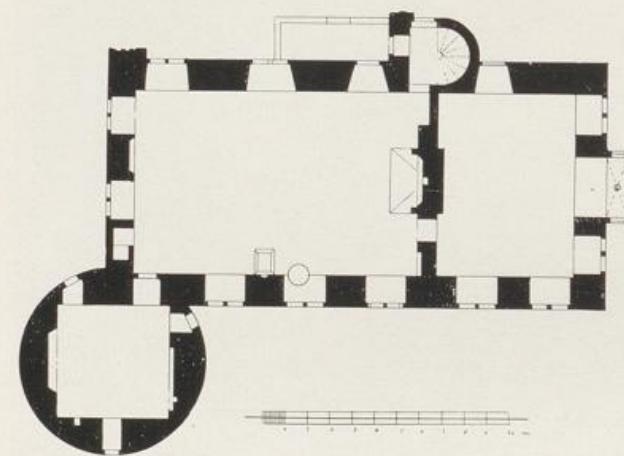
Nörvenich. Grundriss der Harffschen Burg.
